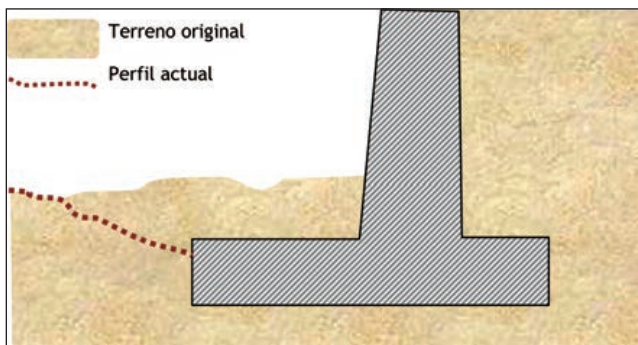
SOCACCIÓN FUERTE EN ESTRIBO.
